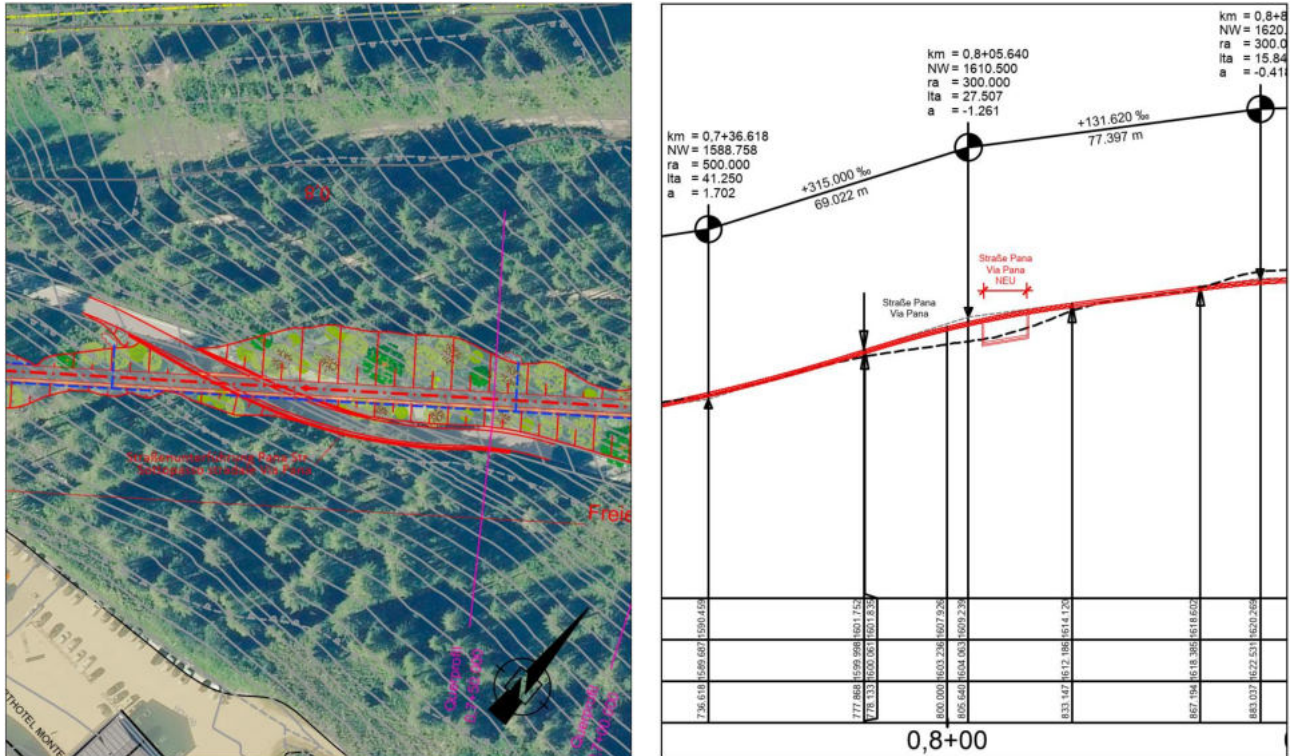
Auszug Lageplan und Längenschnitt Überquerung Pana Straße Bereich Km 0,8
